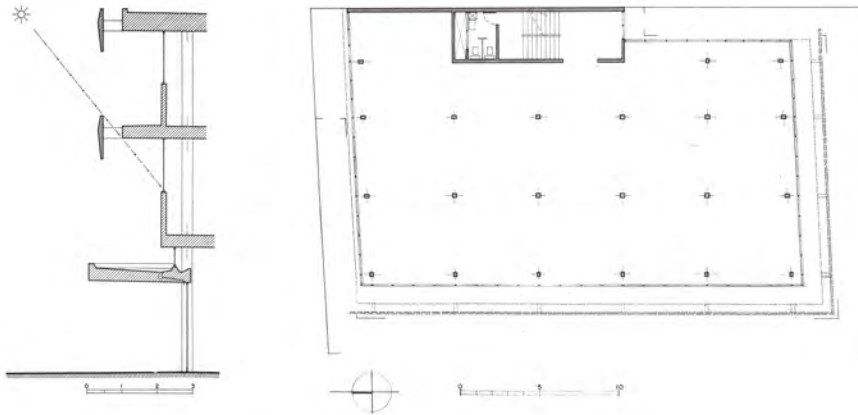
Bürogebäude Union (1964 – 1965), Schnitt durch den Sonnenschutz; Grundriss
